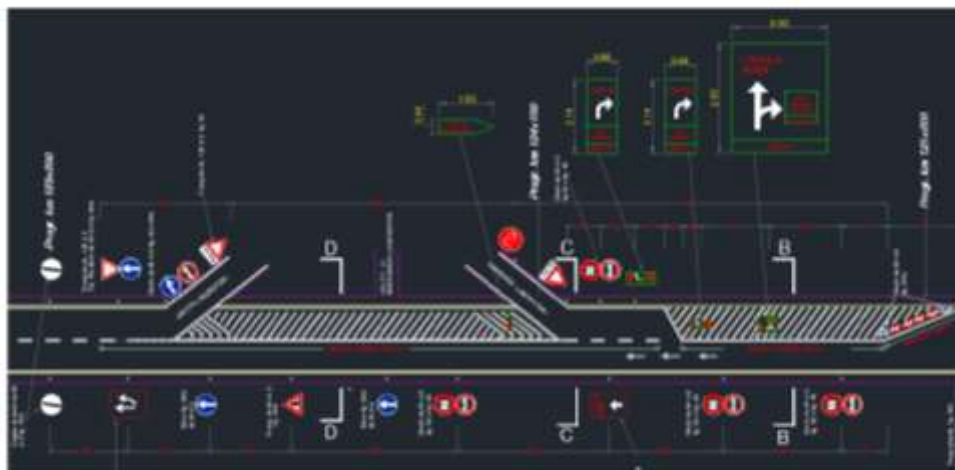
Schema progetto ripasso zebraura all'interno del tunnel del Gran Sasso.
